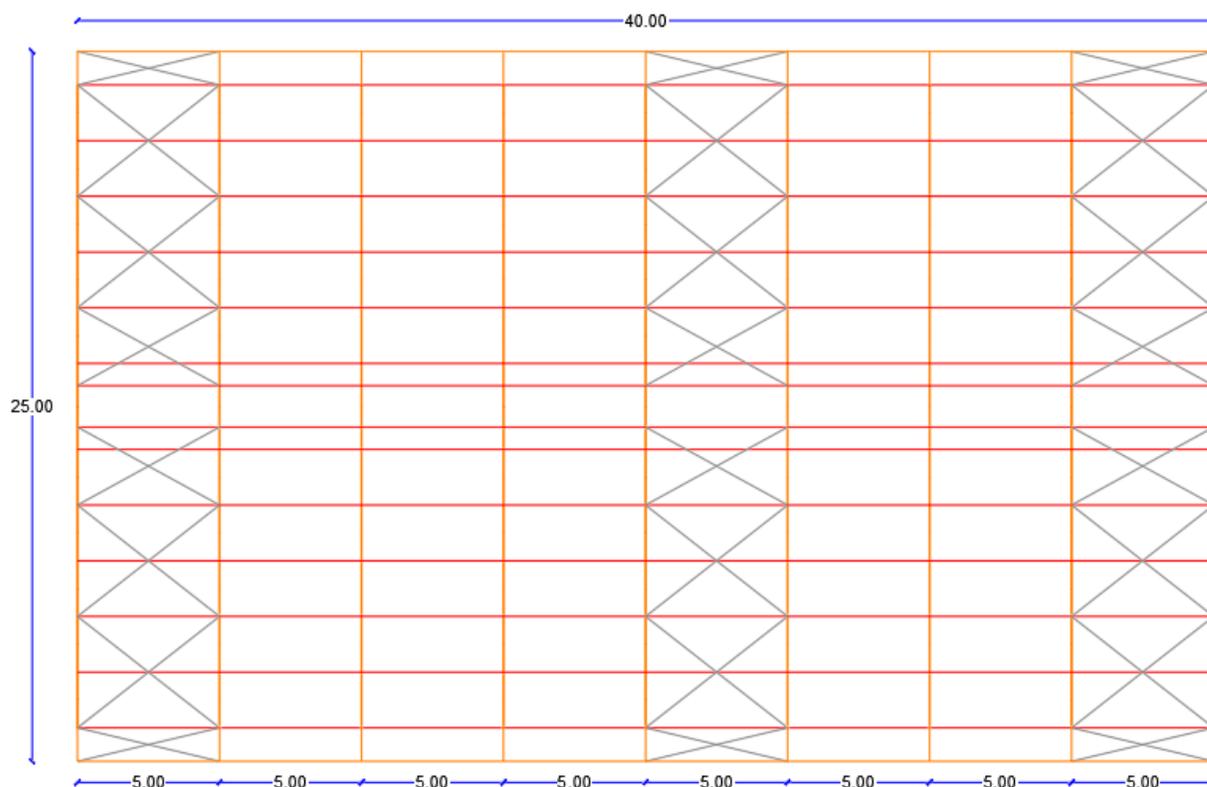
Implantación de Galpón. (Suquilanda, 2024)
